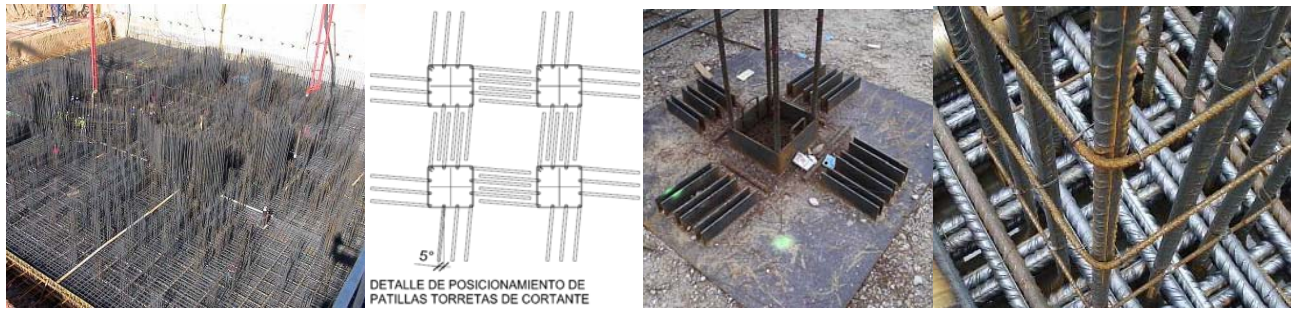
Vista general y detalles del ferrallado de la primera tongada.
